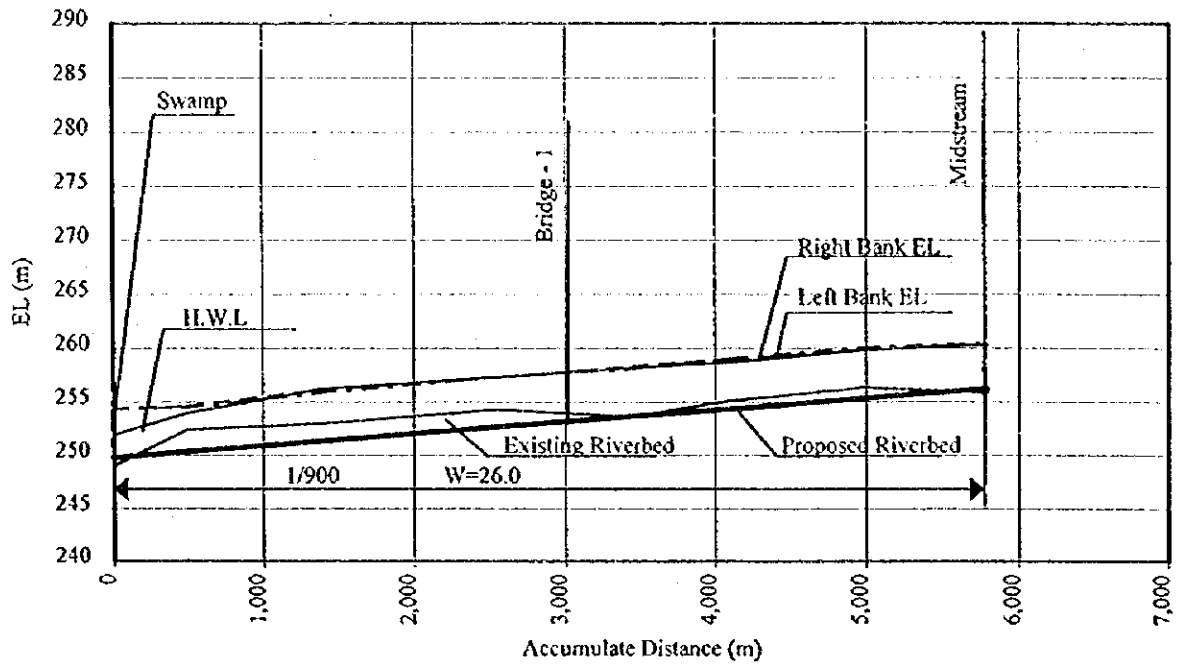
(3) PERFIL LONGITUDINAL DEL ARROYO TACUARAL
